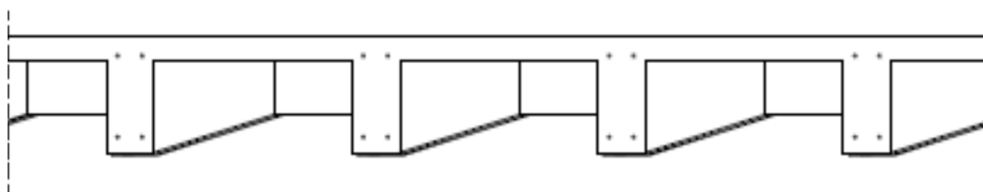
Reforzamiento a flexión con materiales compuestos de una placa con viguetas: sección transversal.
